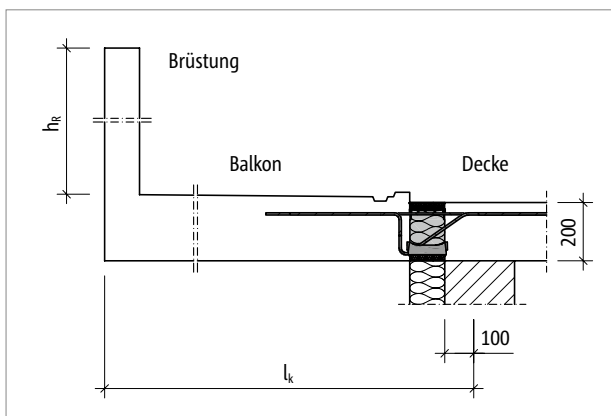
Schöck Isokorb® XT Typ K: Statisches System
